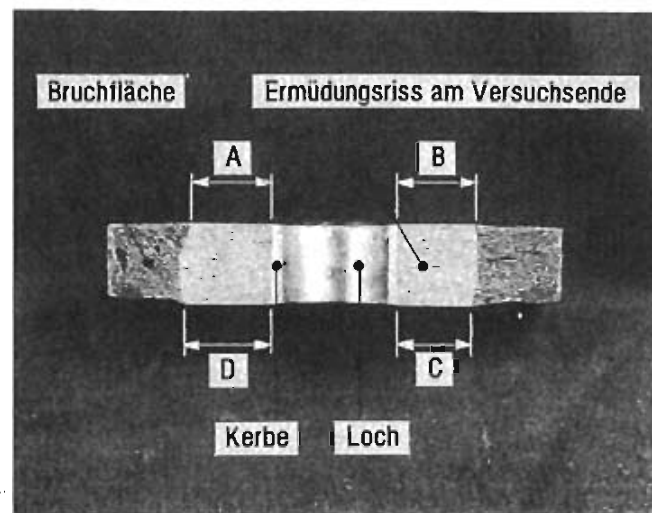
Rißoberfläche eines Probekörpers aus Schweißeisen
